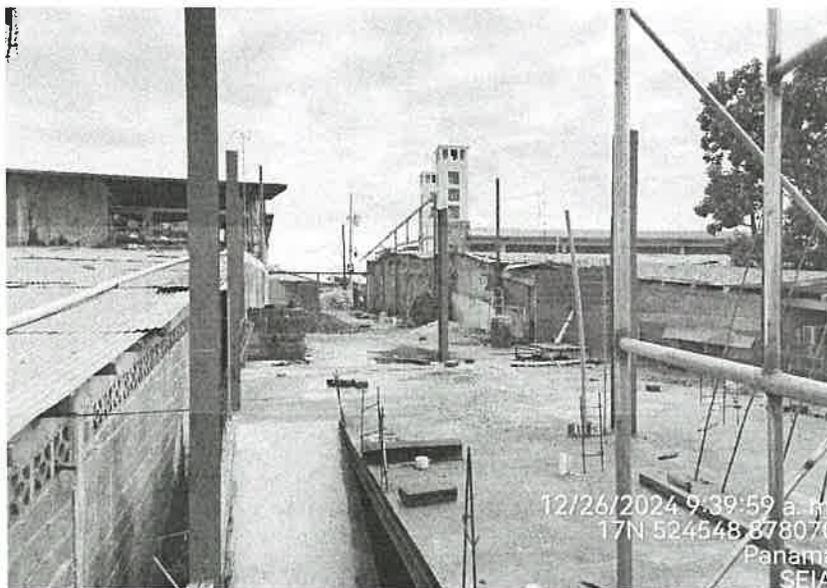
Otra vista desde la parte posterior, se observa armado de barras de acero, salidas de tubería sanitaria e instalación de vigas H para soporte de losa.
